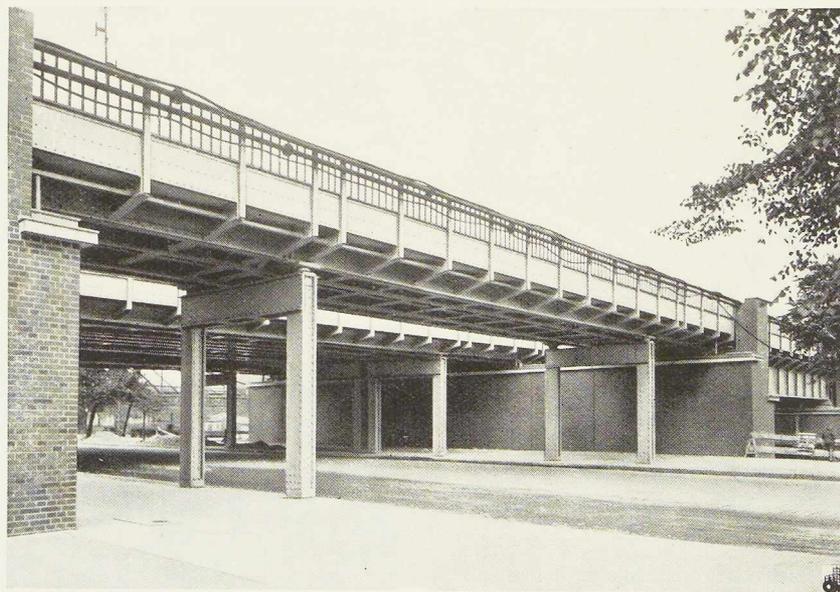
Portiques rivés dont les éléments ont une section en caisson.
